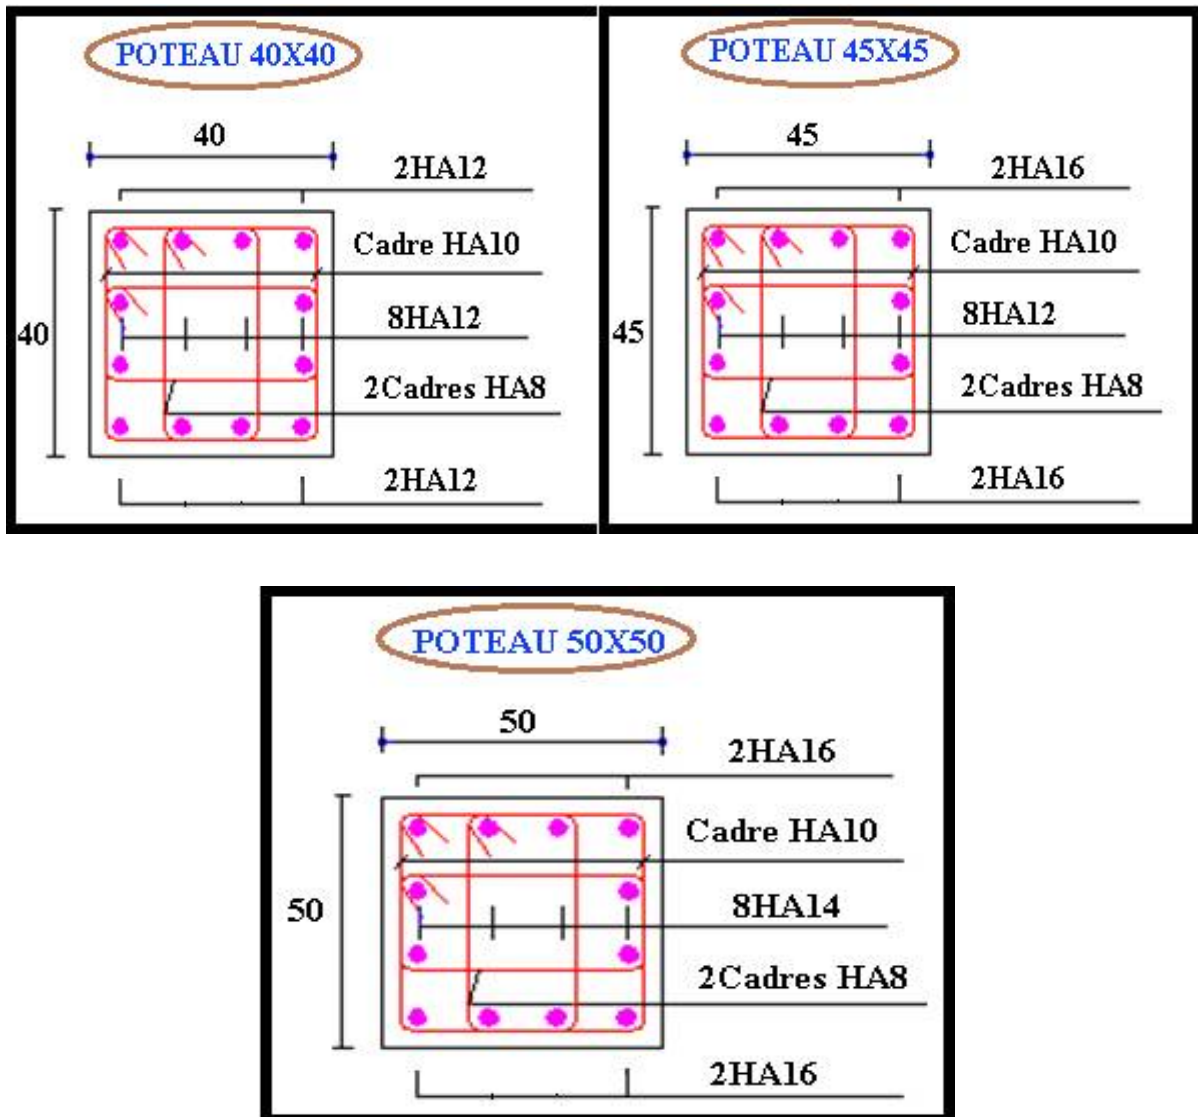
Schéma de ferrailage des Poteaux carrés.
